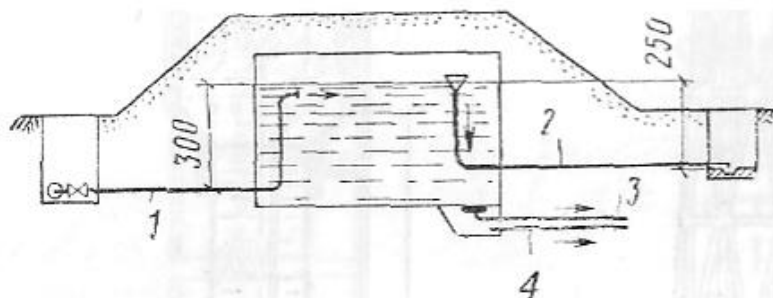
Схема оборудования резервуара чистой воды трубопроводами
